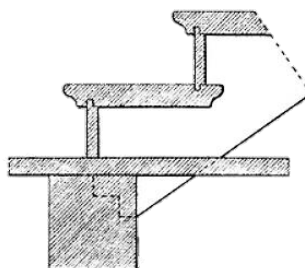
Опора тетивы деревянной лестницы на специальную балку перекрытия. Г.В. Кирштейн, 1899 г. [2]
